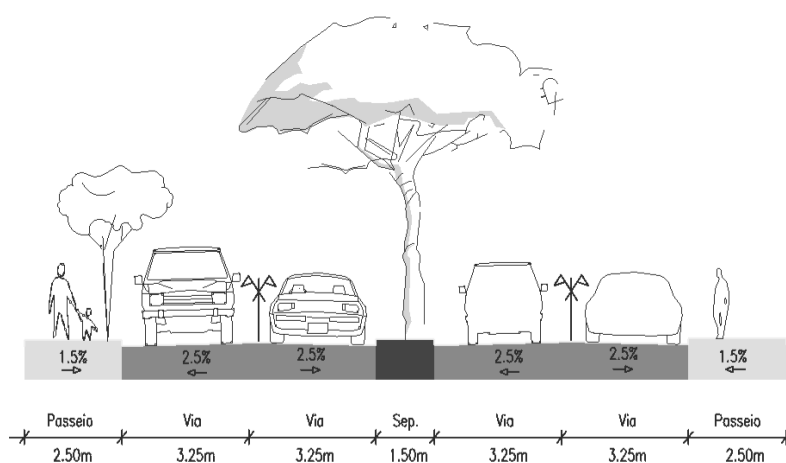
Perfil Transversal Tipo 1 – Eixos 1, 2 e 3
